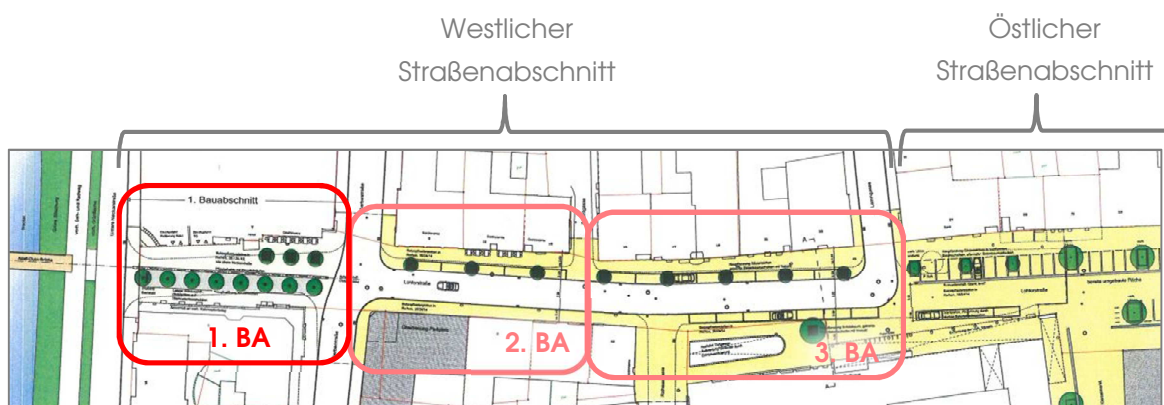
Planskizze der gesamten Lohtorstraße (Stand: 2006). Lediglich der erste Bauabschnitt wurde ausgeführt. Der zweite und dritte Bauabschnitt wurden zunächst zurückgestellt.
